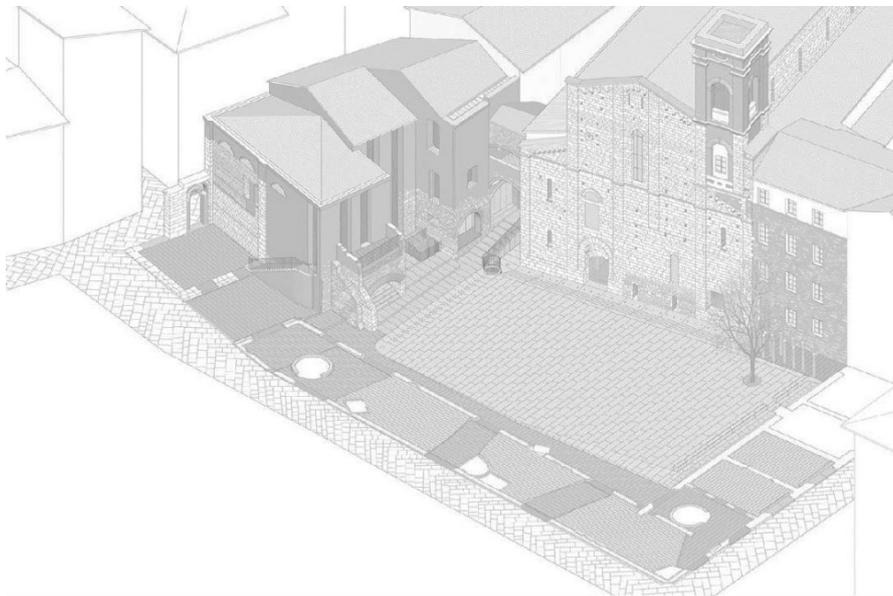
Spaccati assometrici dell'intervento, con la sistemazione della piazza così come prevista nel progetto
